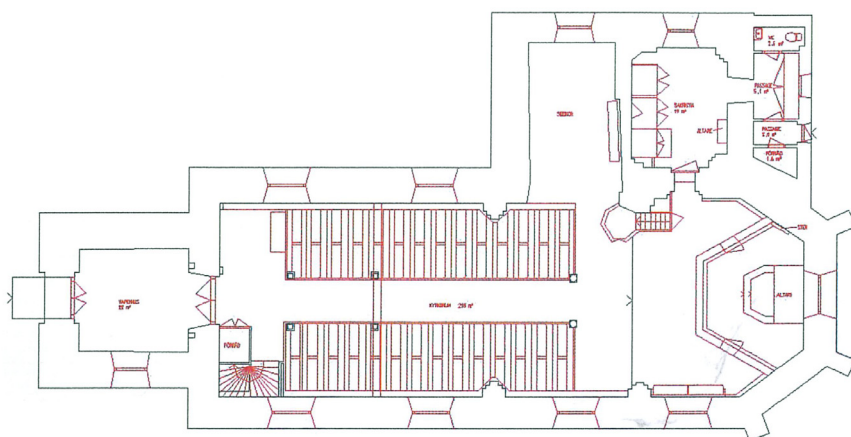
Planritning av kyrkan. Bild ur: Vård- och underhållsplan, Hammarskiöld 2005.
